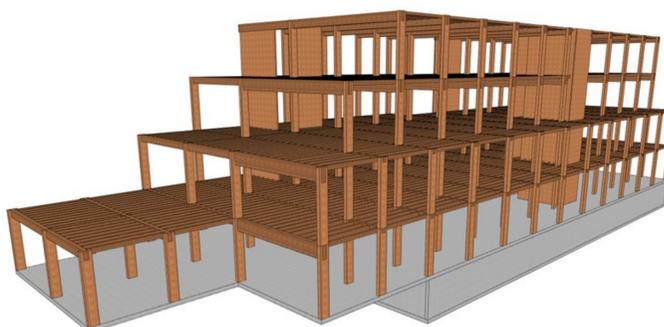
Tragwerk SKZ (ohne Betonschicht)
